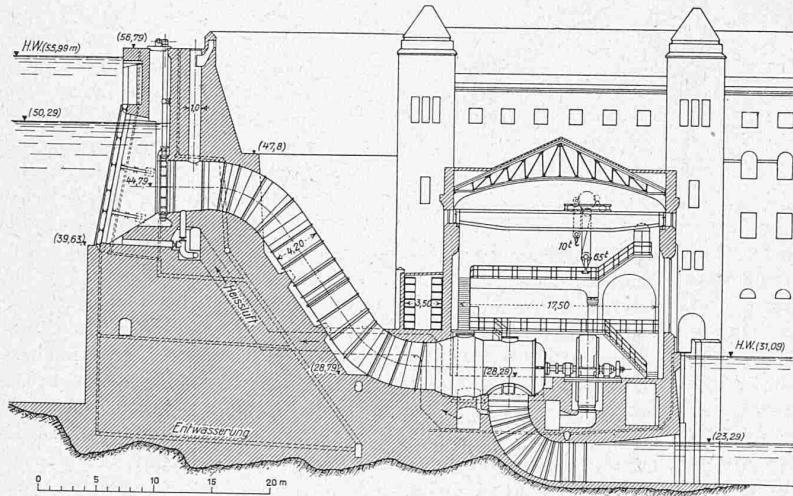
Querschnitt durch Stauwehr und Maschinenhaus. — Massstab 1:600.
